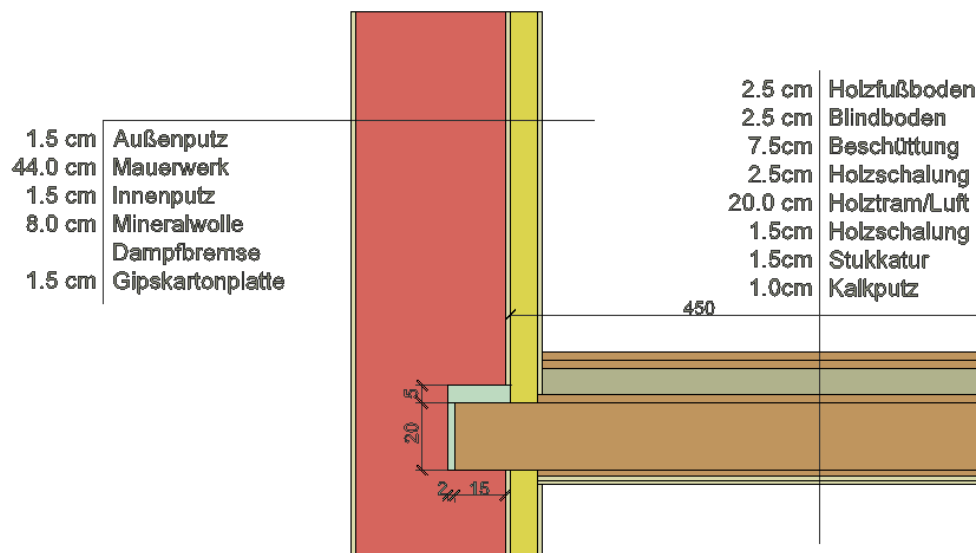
Geometrie – Schnitt durch den Deckenbalken
